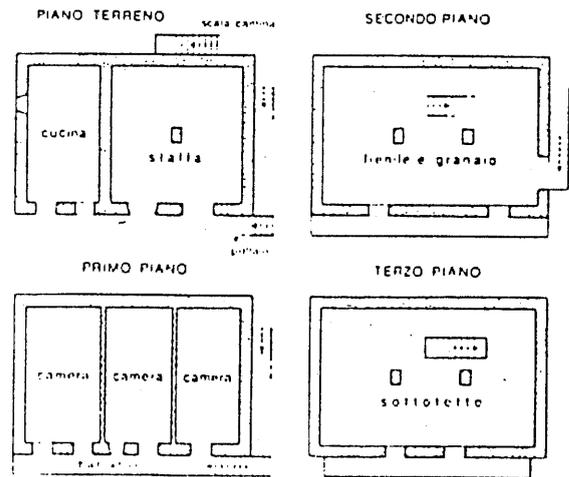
Pianta tipo (2): casa e rustico disposti in sezioni verticali
